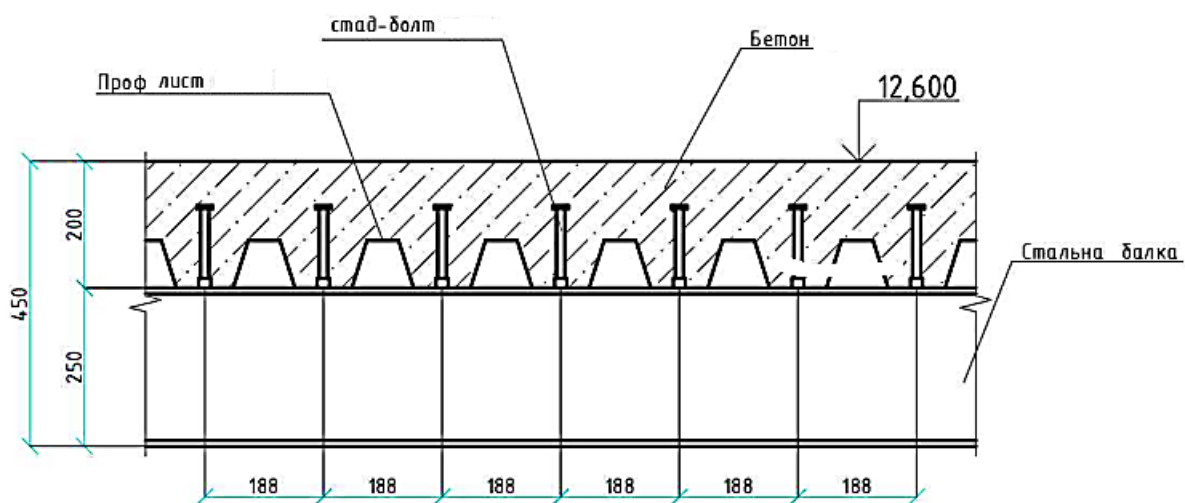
Конструкція сталезалізобетонного перекриття
